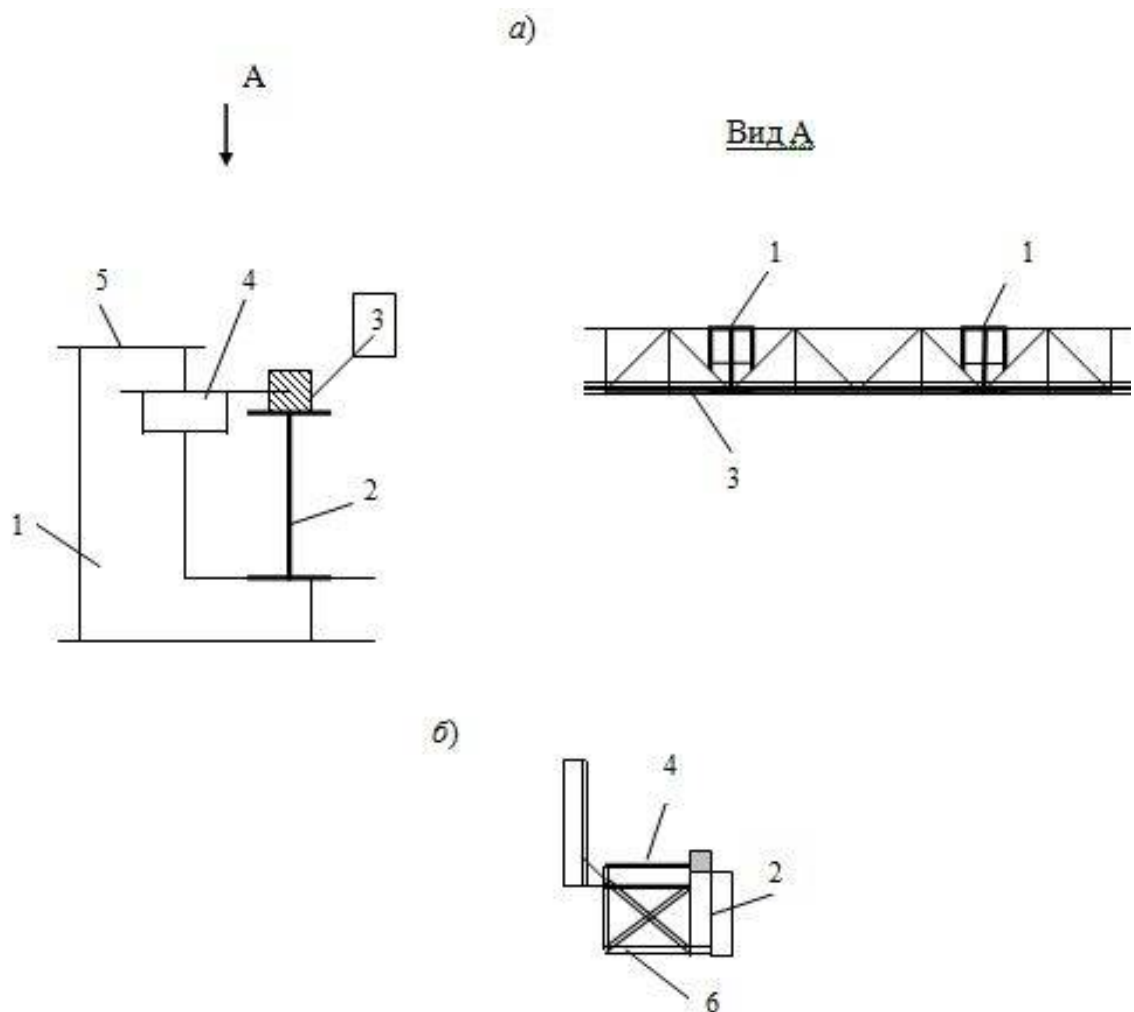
Схемы тормозных балок (а) и ферм (б) :
